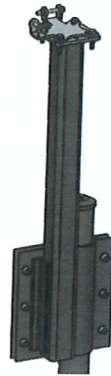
Dispositivo de anclaje solapado al pie derecho (alternativa 1)
